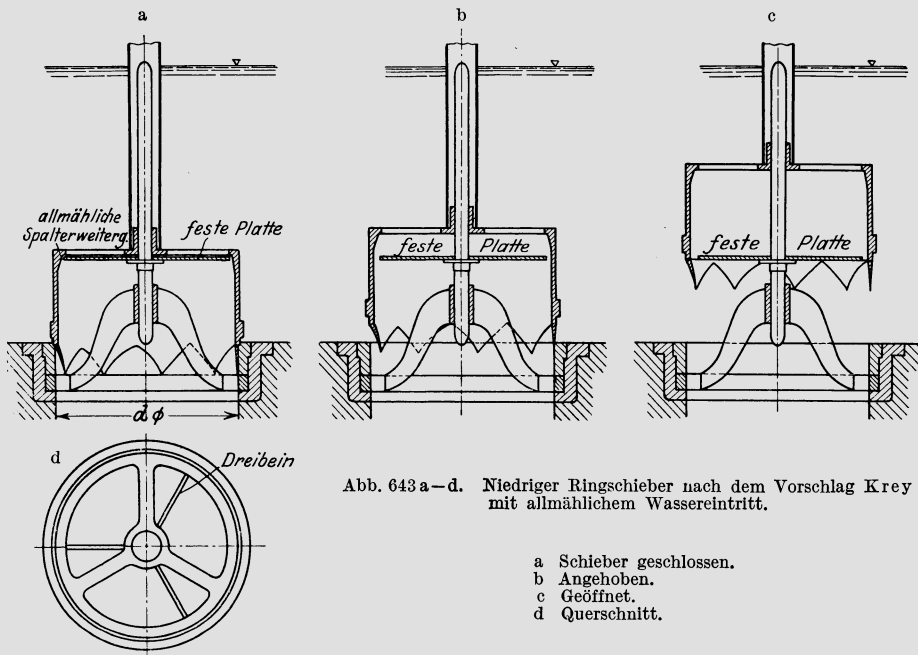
a–d. Niedriger Ringschieber nach dem Vorschlag Krey mit allmählichem Wassereintritt.
